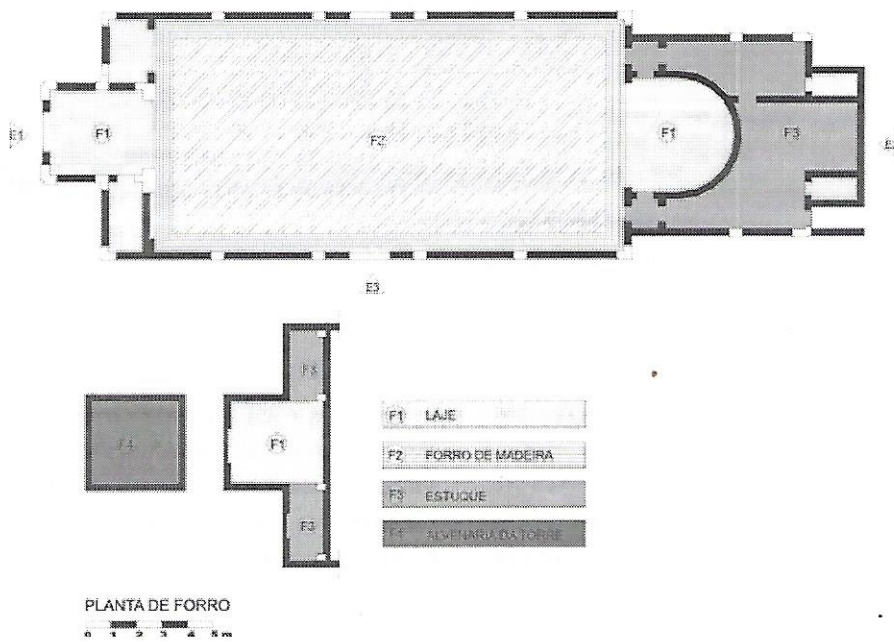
Planta dos tipos de forros da Igreja Nossa Senhora das Dores.
